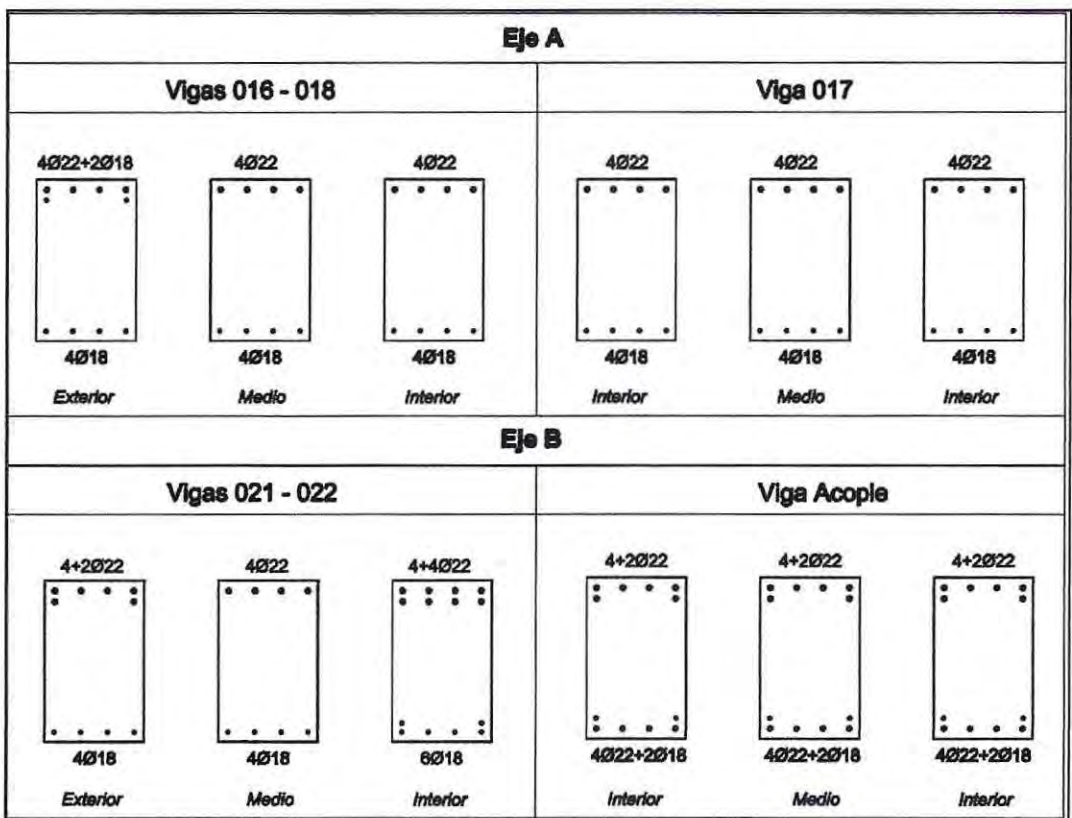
Armadura a flexión de vigas en estructura mixta, Ejes A y B.
